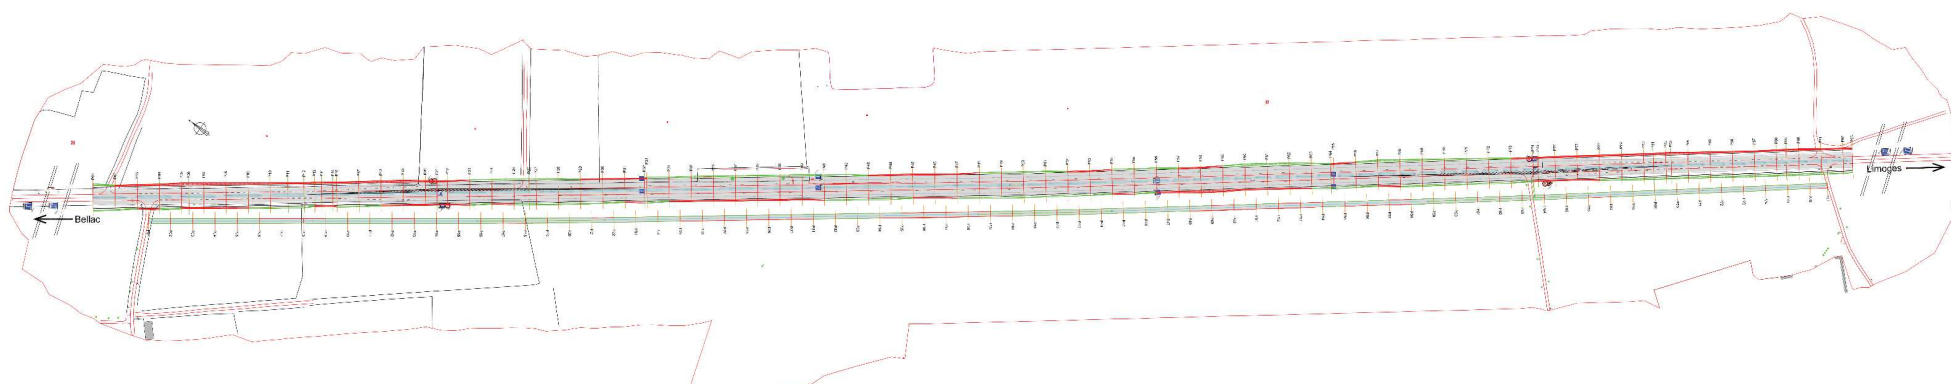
Section Berneuil créneau en place élargissement de part et d'autre, vue en plan
